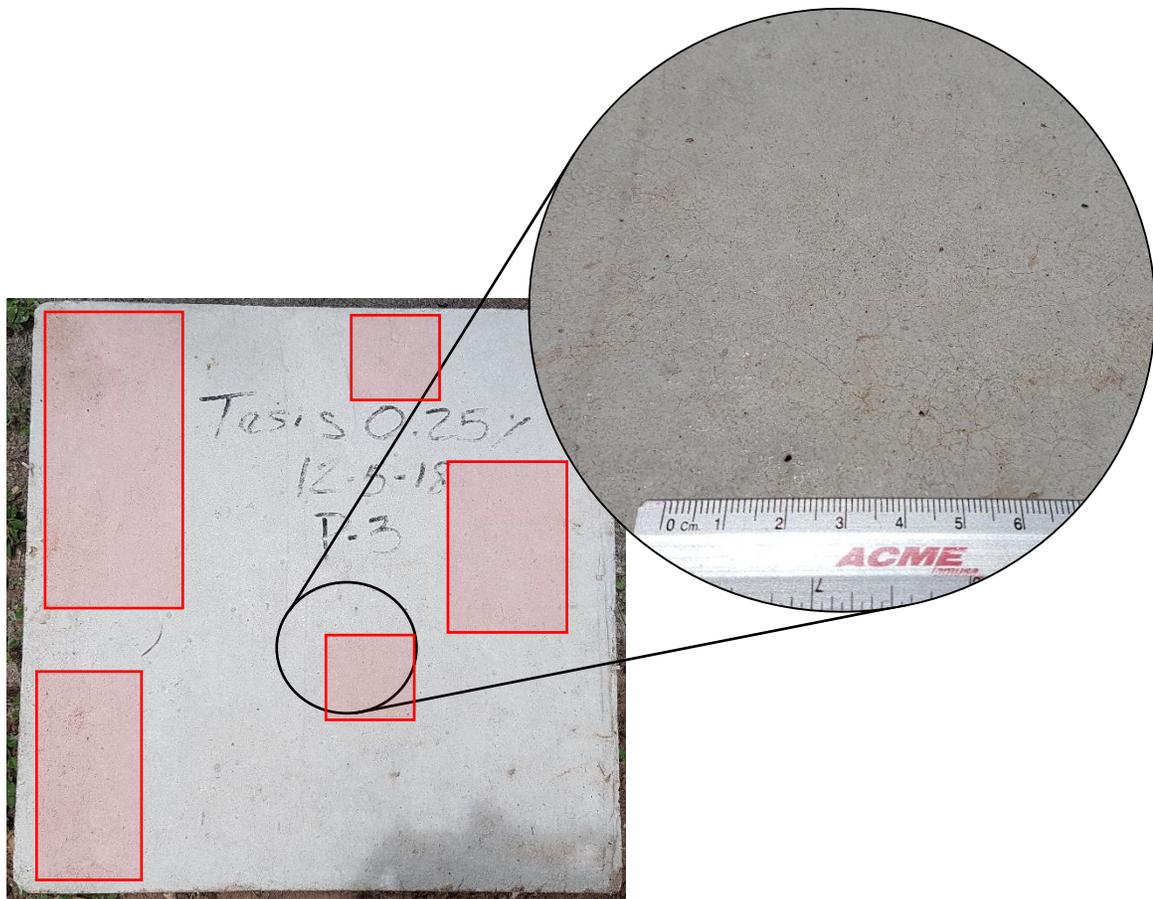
Losa CONCREPET con 0.25% de fibra, 30% fisurada a 21 días
